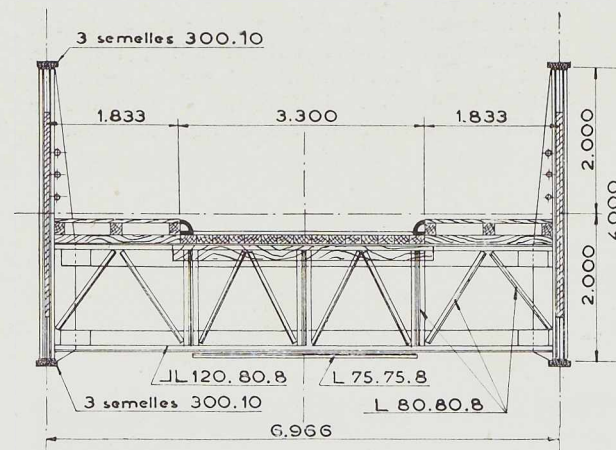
à 572. Plan d'ensemble et coupes du pont reliant le quai au ponton flottant.
